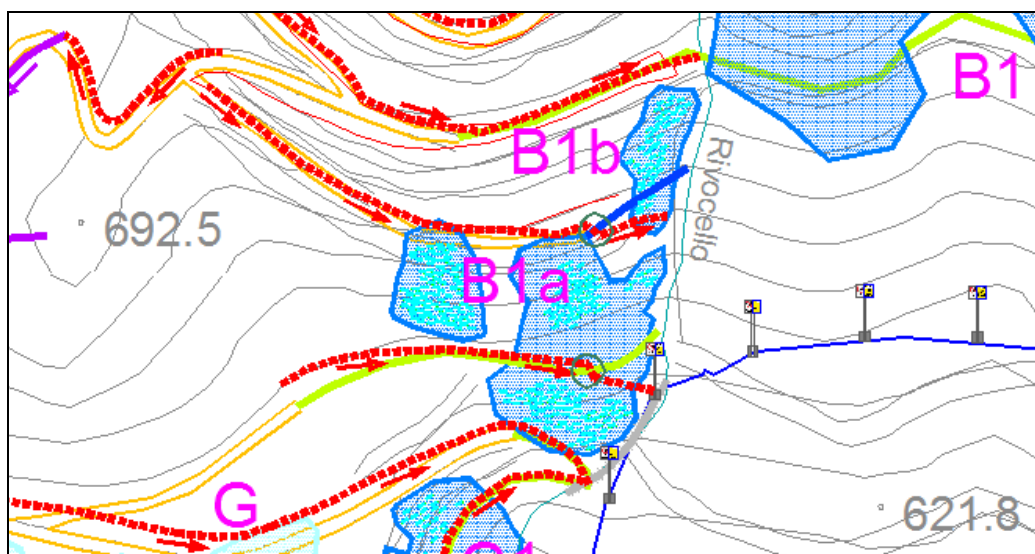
Unità progettuale B1a (cfr. elaborato C2 - Planimetria generale di progetto)
